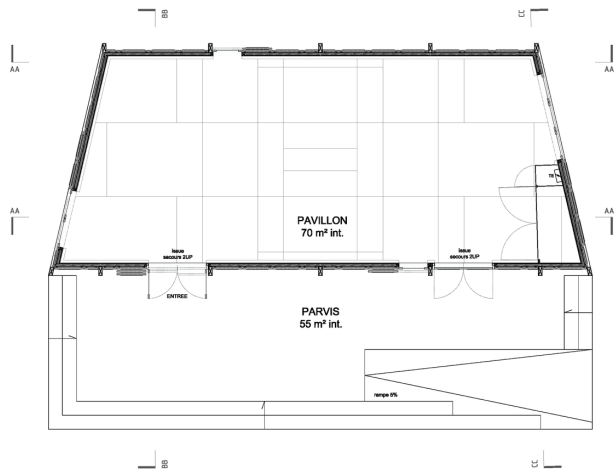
Pianta piano terra; Fonte: <http://www.archdaily.com/>;
